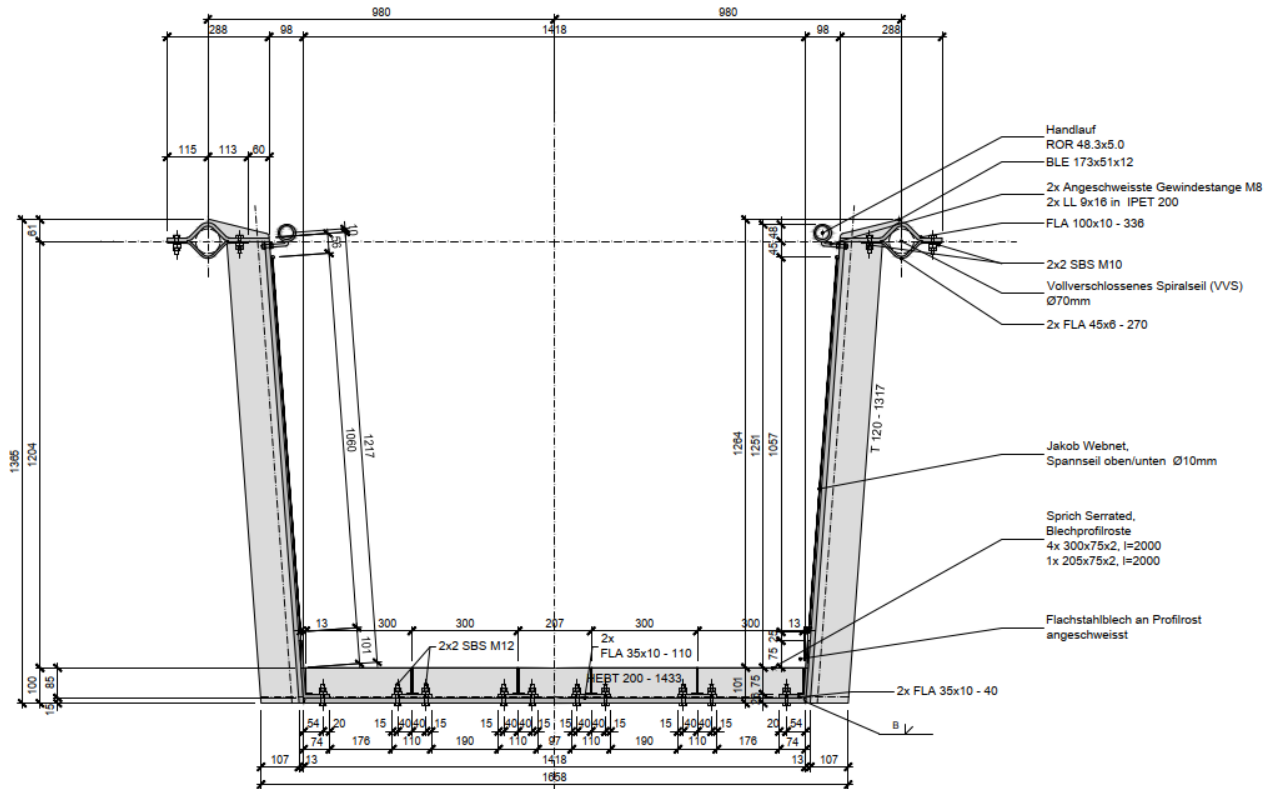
Querschnitt Stahlrahmen, Details Stahlbau
